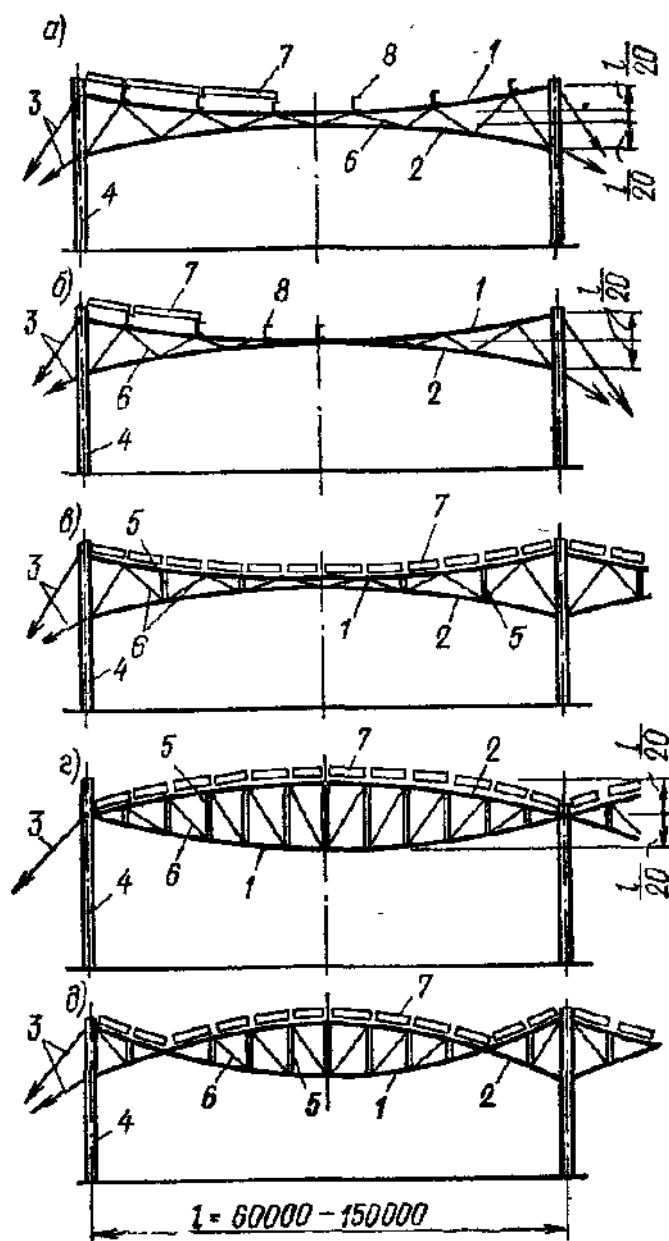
, б. Схемы вантовых предварительно напряженных ферм:
